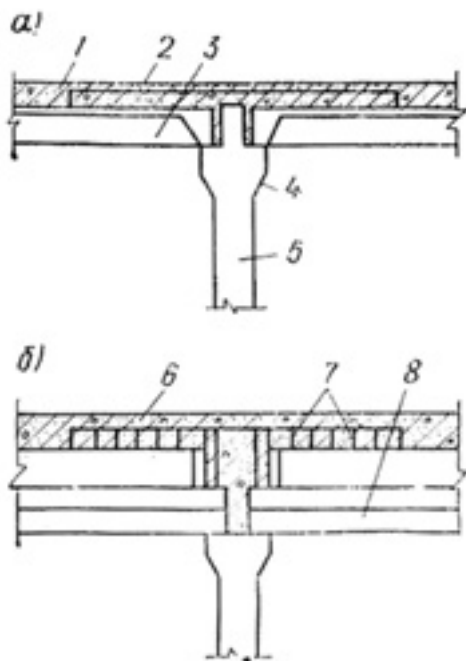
Установка надпорной арматуры в сборно-мономитном перекрытии убежища: а – в неразрезных плитах; б – в неразрезных ригелях; 1 – слой мономитного бетона; 2 – надпорная арматурная сетка в плите; 3 – плита; 4 – ригель; 5 – колонна; 6 – надпорная арматура ригеля; 7 – выпуски поперечной арматуры из ригеля; 8 – ригель (плиты не показаны)
